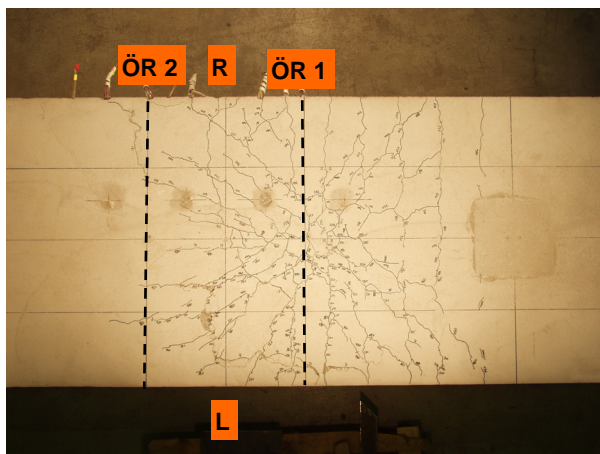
Rissbild auf der Betongurtoberseite
